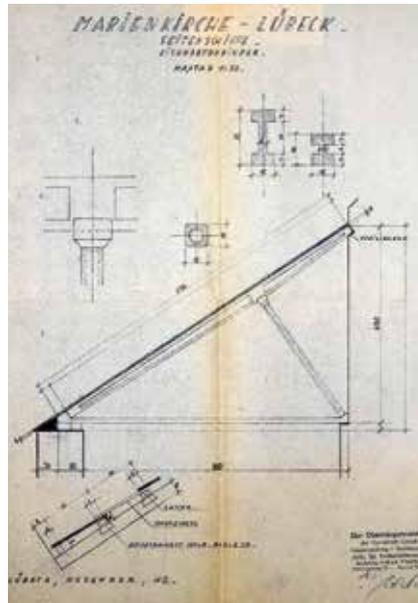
Entwurf für das Seitenschiffdach in Betonkonstruktion von Walter Herbst, November 1942 (Foto: Nachlass Overhage)
